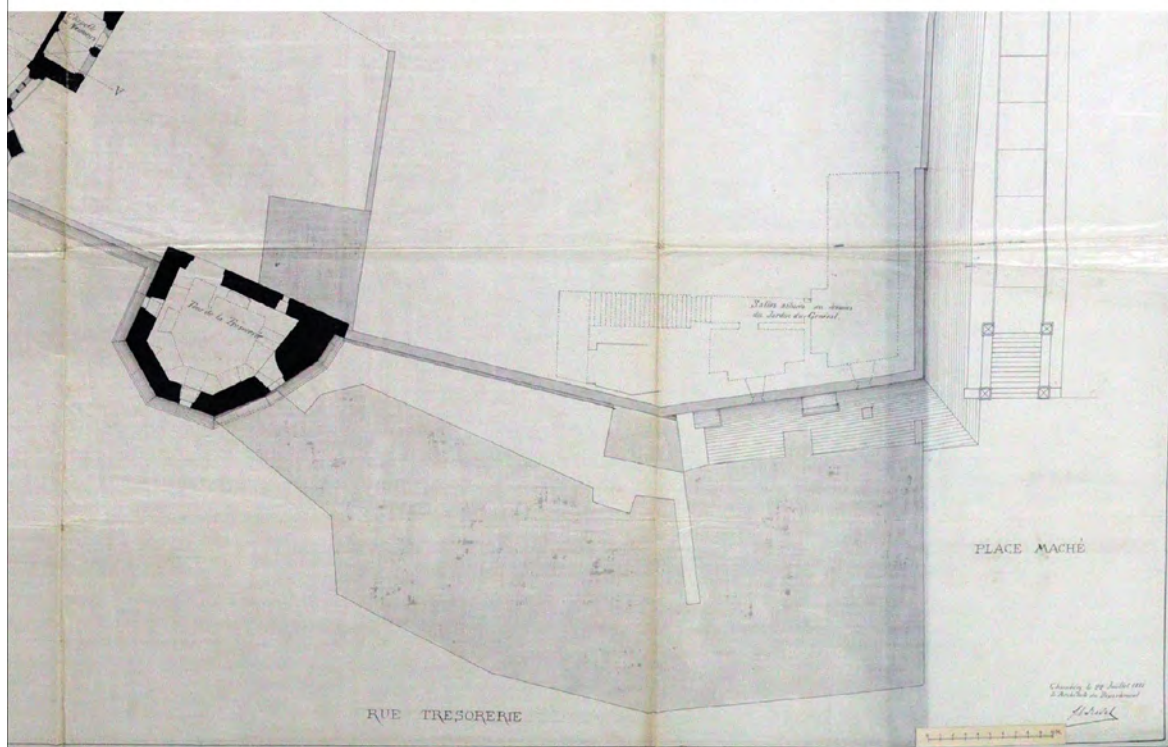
Château de Chambéry. Plan du château et des Salles basses en 1882. Doc. : Médiathèque du patrimoine, n° 28793.
